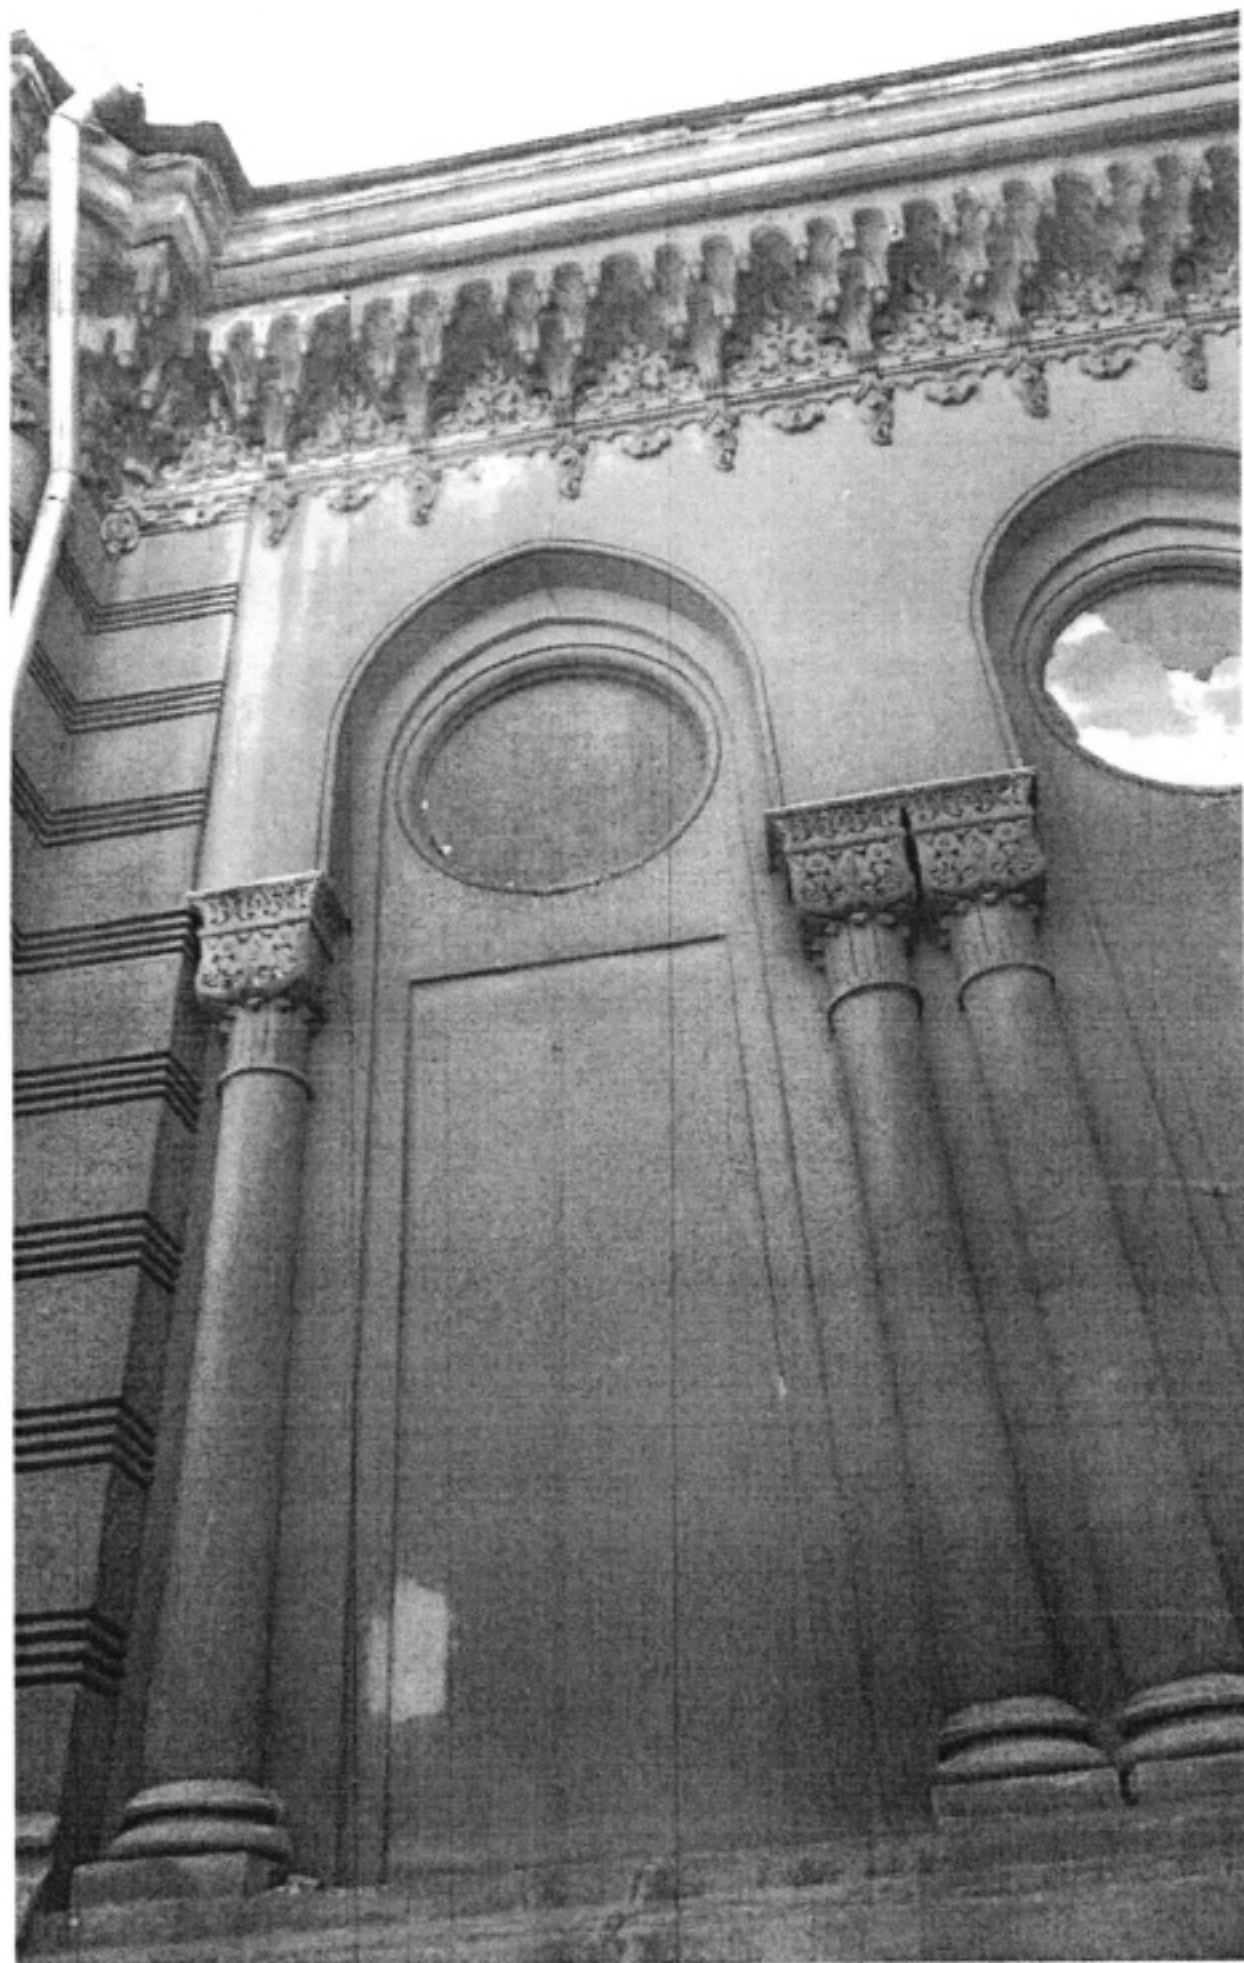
Фрагмент зовнішньої стіни з вертикальною тріщиною з шириною розкриття до 7.0 мм на всю висоту будівлі.
